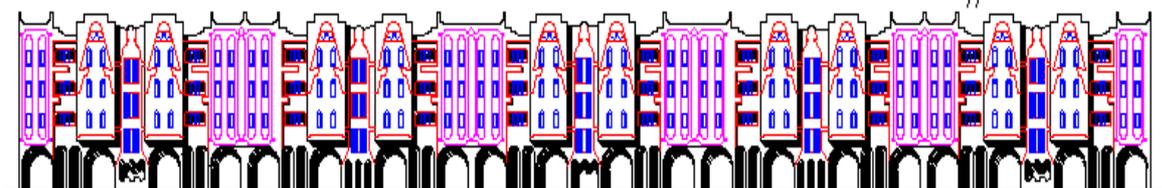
Les façades proposées de côté et d'autre de la place.
